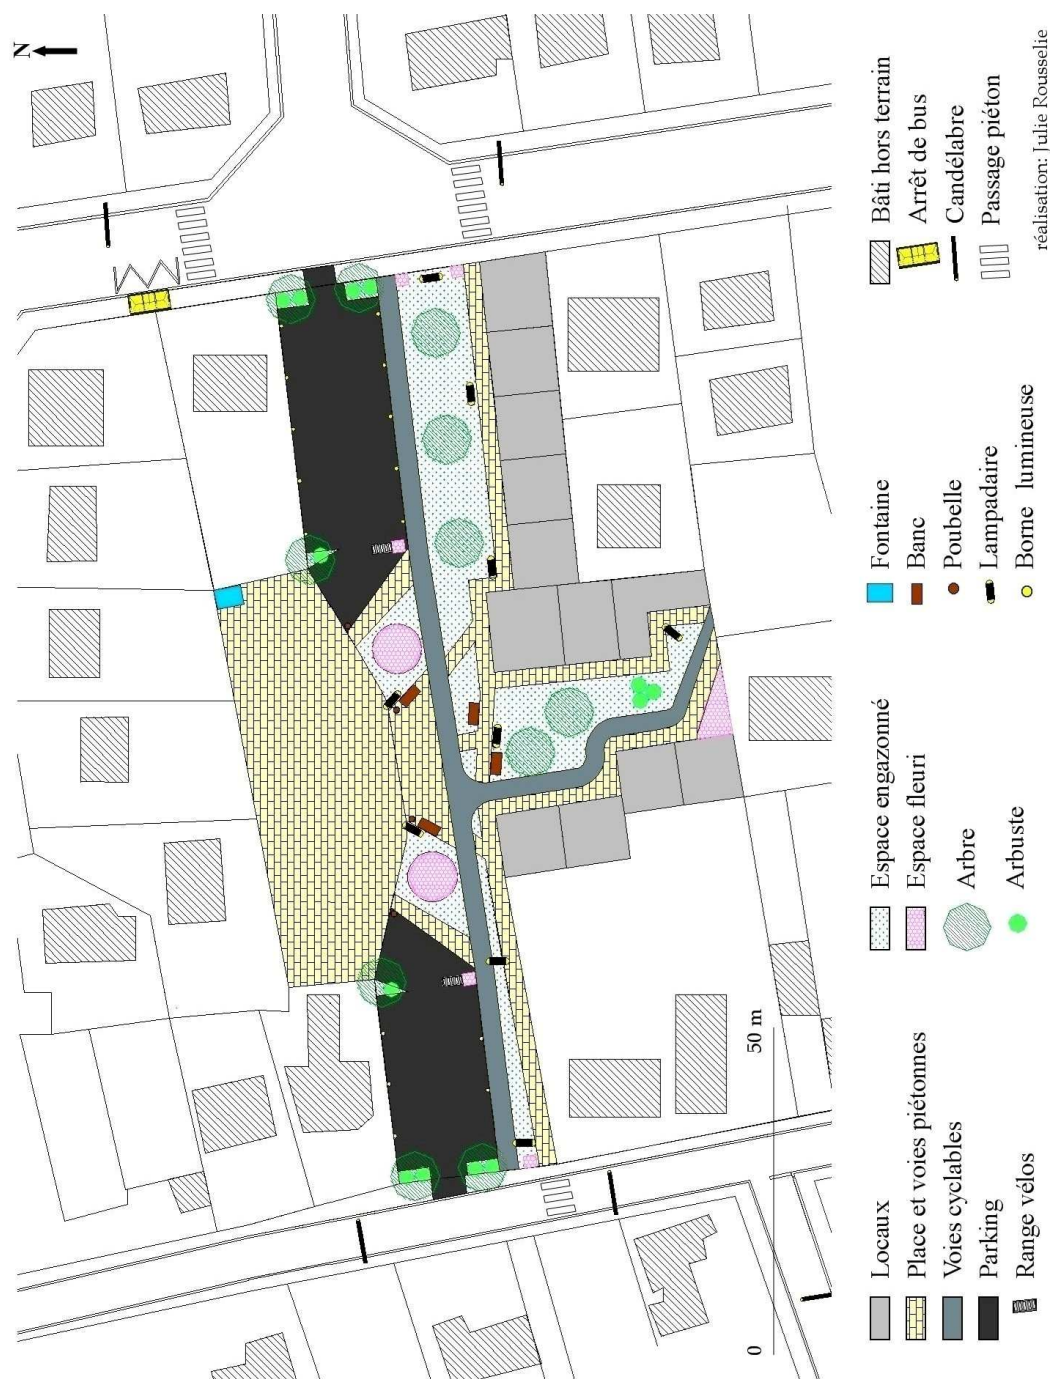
Propositions d'aménagement de l'îlot : plan masse
